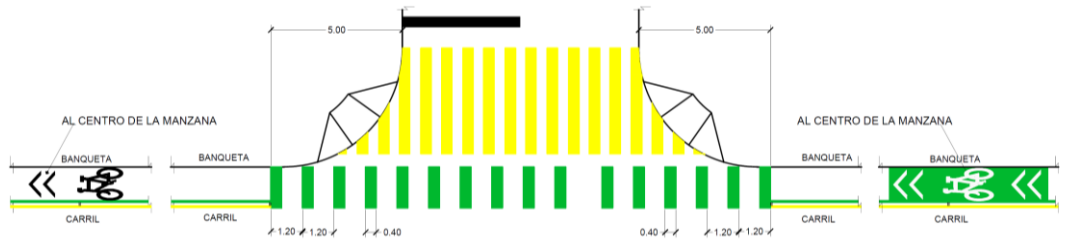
Detalle de señalamiento horizontal Tipo 1, manzanas menores a 100m.
